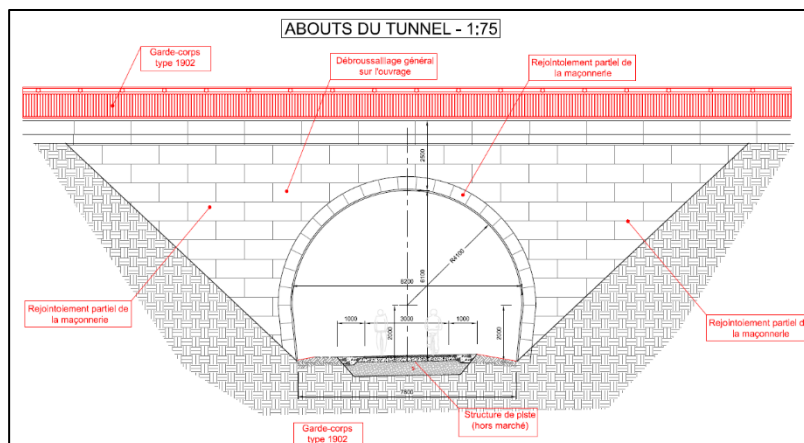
Coupe - travaux sur les têtes du tunnel
